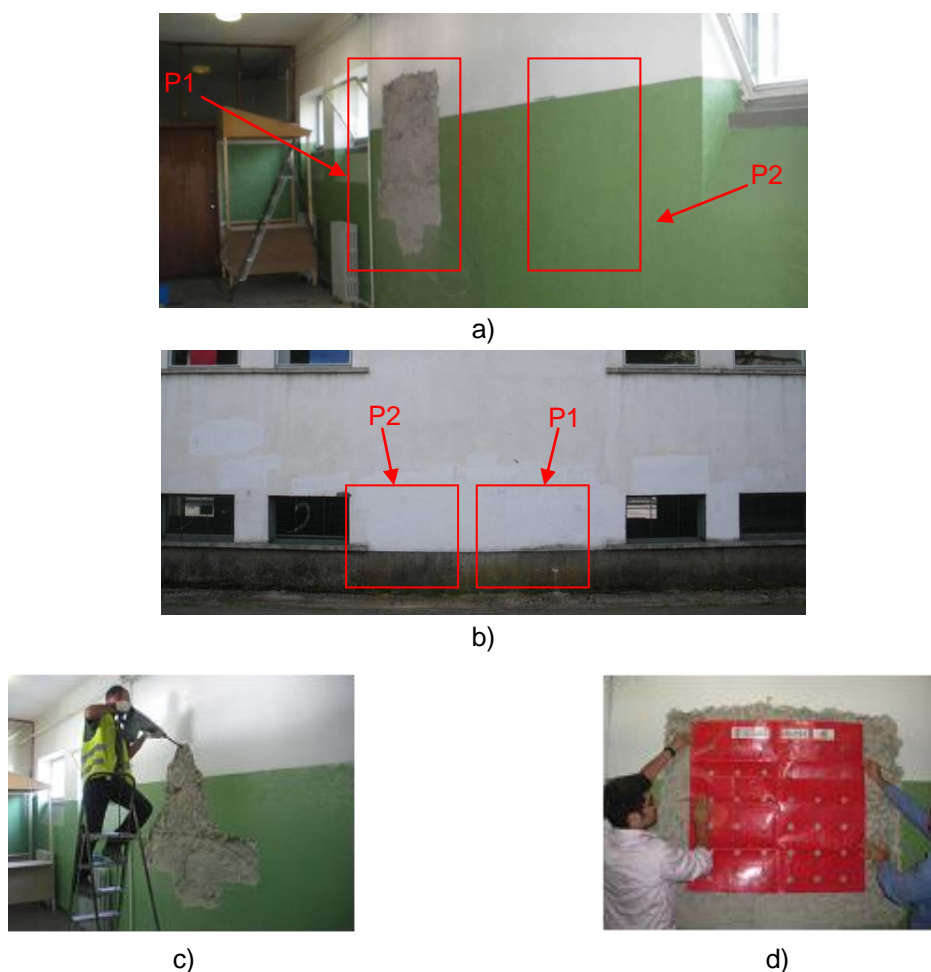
Ensaio sónicos: a) locais P1 e P2 vistos do interior; b) locais P1 e P2 vistos do exterior; c) preparação do local P1 (remoção do reboco); d) marcação da matriz de 6x6 pontos em P1.
